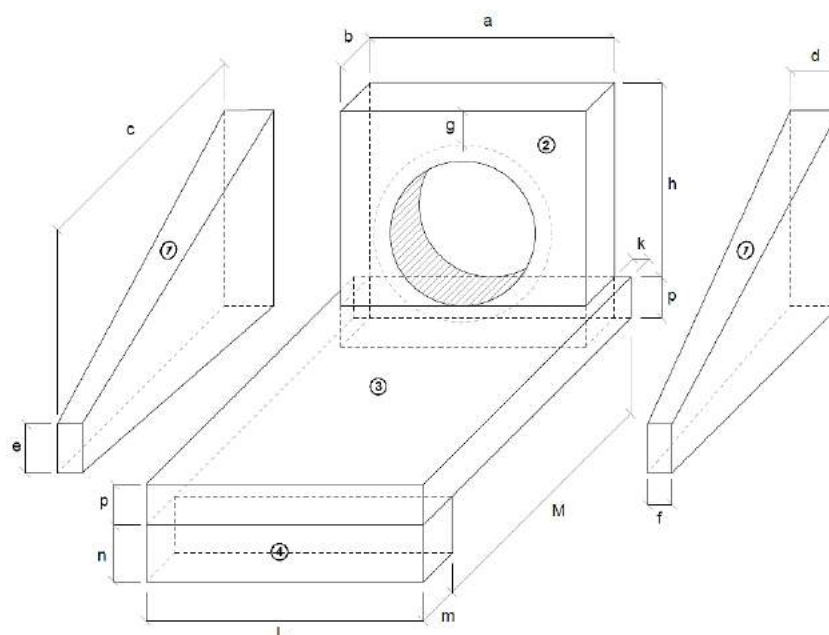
Detalhamento das dimensões da boca de bueiro simples com alas retas -
